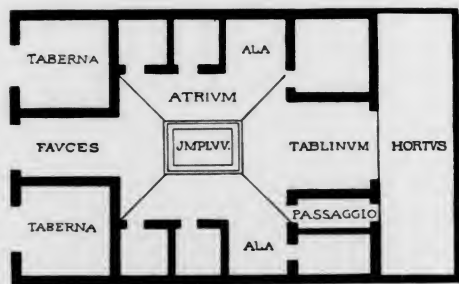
Planta dell'antica casa italica, quale è ricostruita nelle figure 445 e 446.
